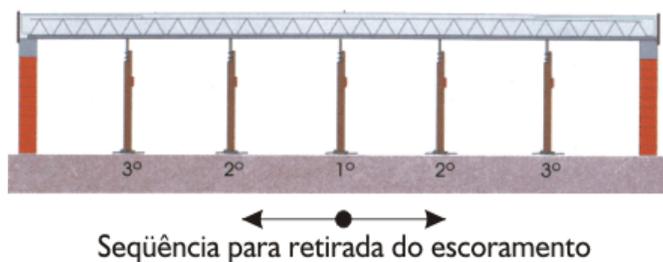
Retirada de escoramentos laje entre dois apoios. Fonte: VIZOTTO (2003)
